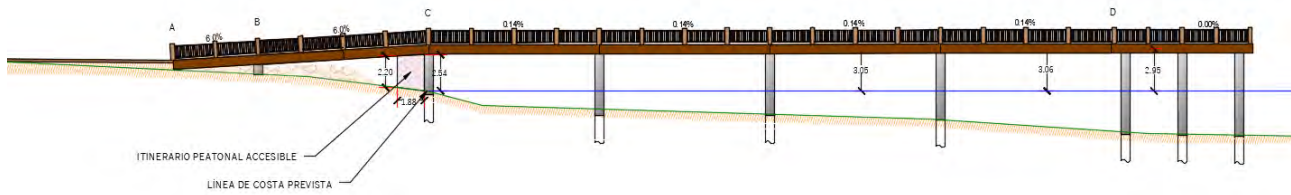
Captura del Plano 02. Perfil longitudinal Alternativa 1 (Anexo 1 Planos).
